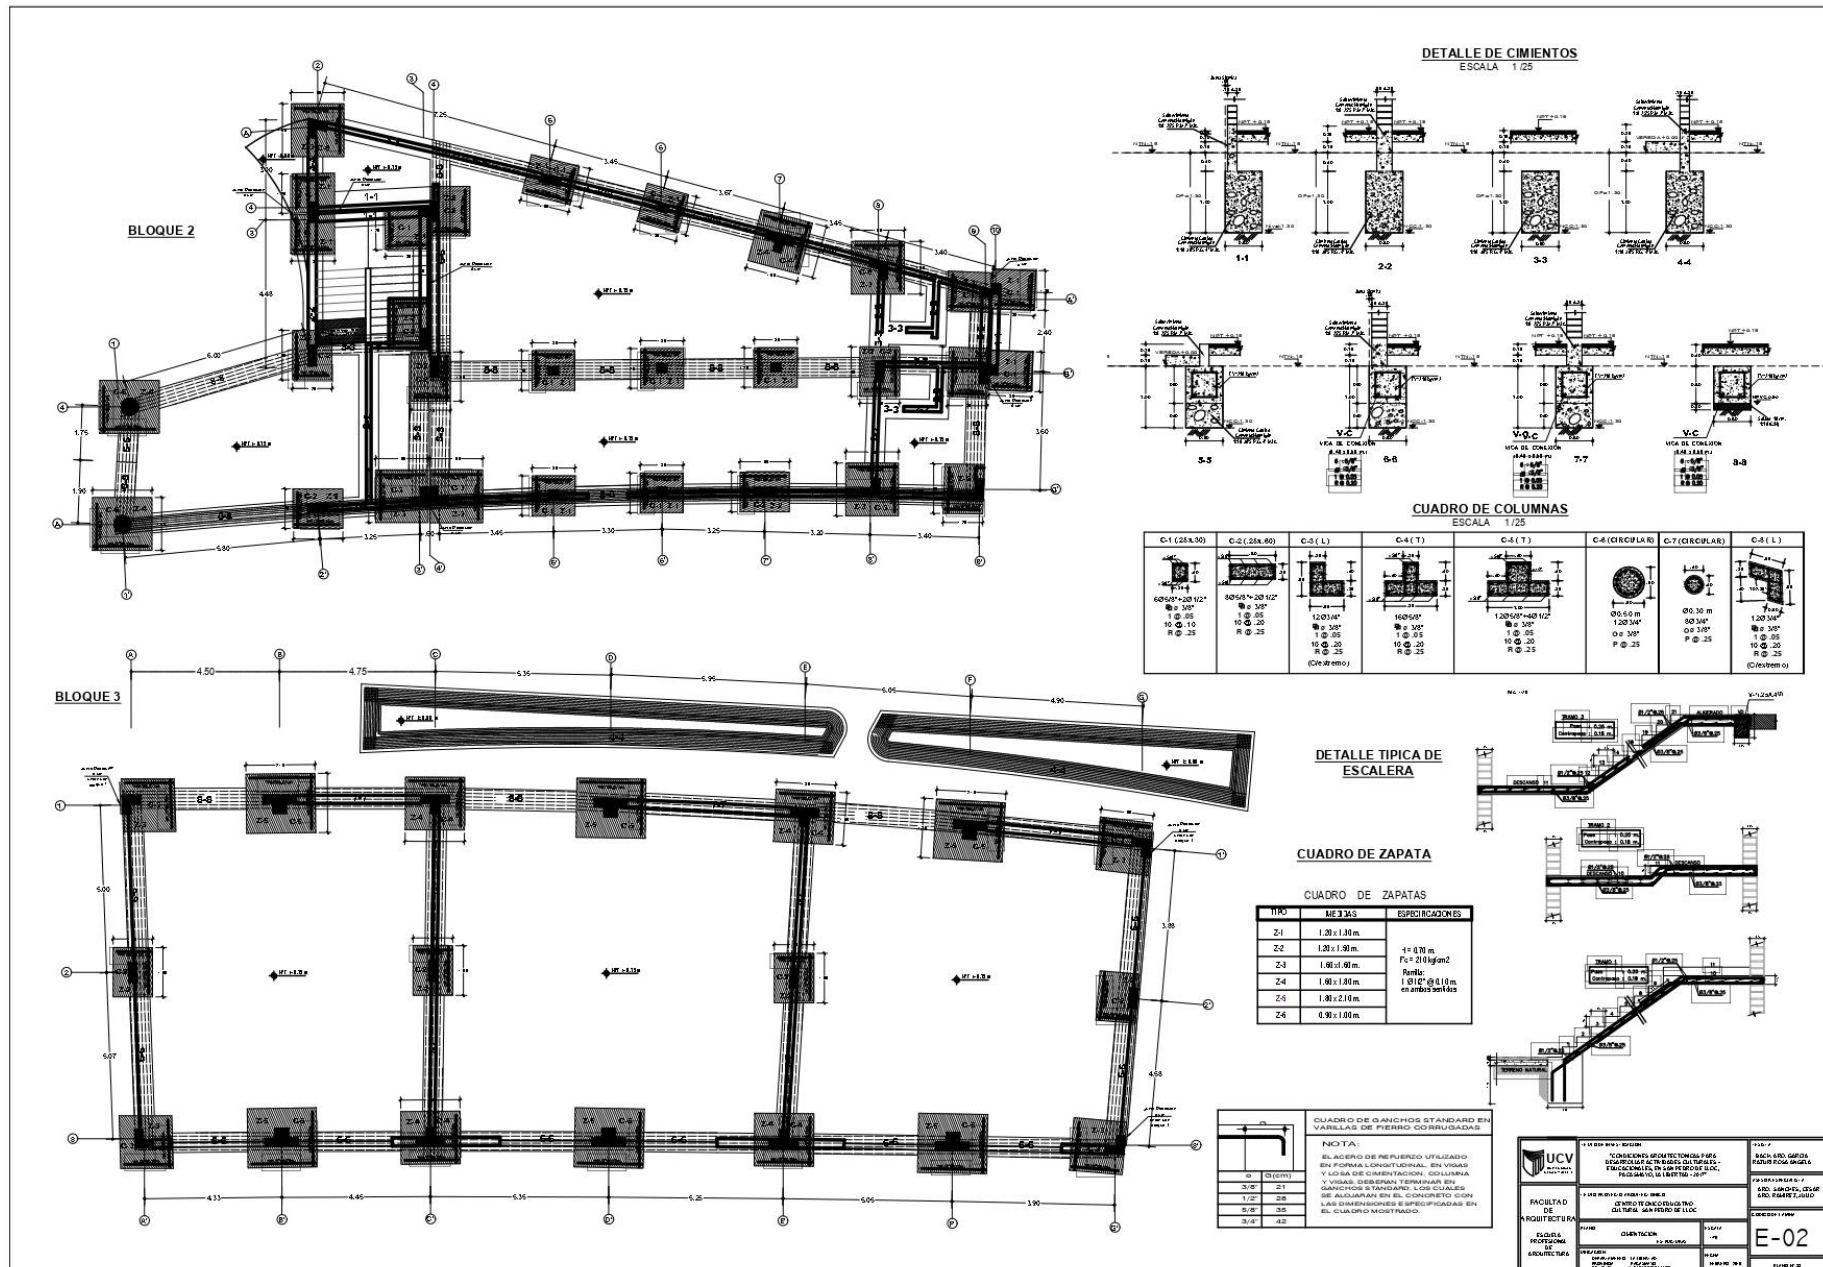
Plano de Cimentación 2do bloque - Plano N° 33 - Lámina N°: E - 02
